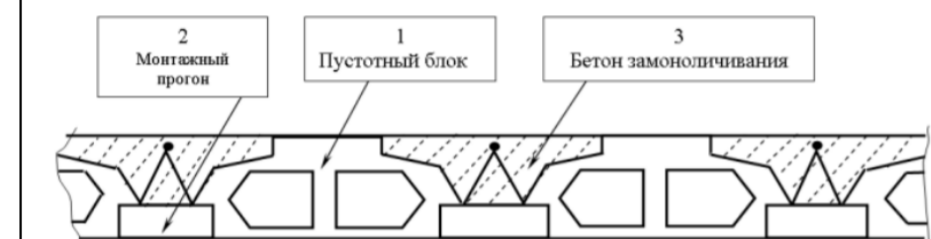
Поперечный переріз перекриття за типом німецької системи «ALBERT»
